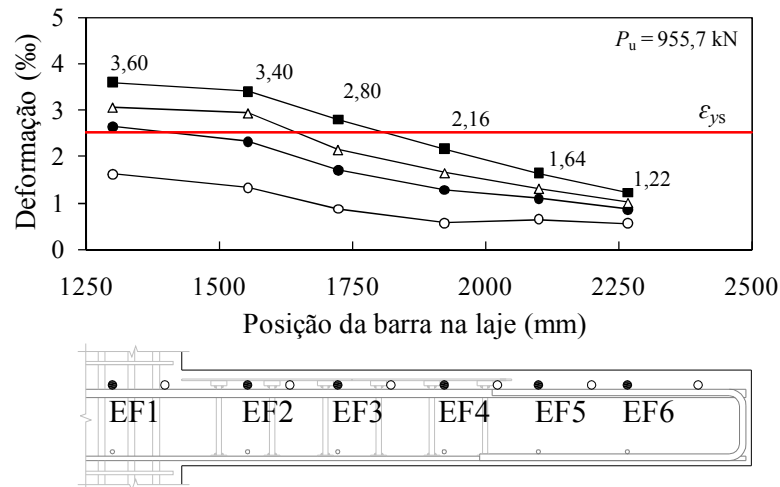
Deformações nas armaduras de flexão da laje LC02
